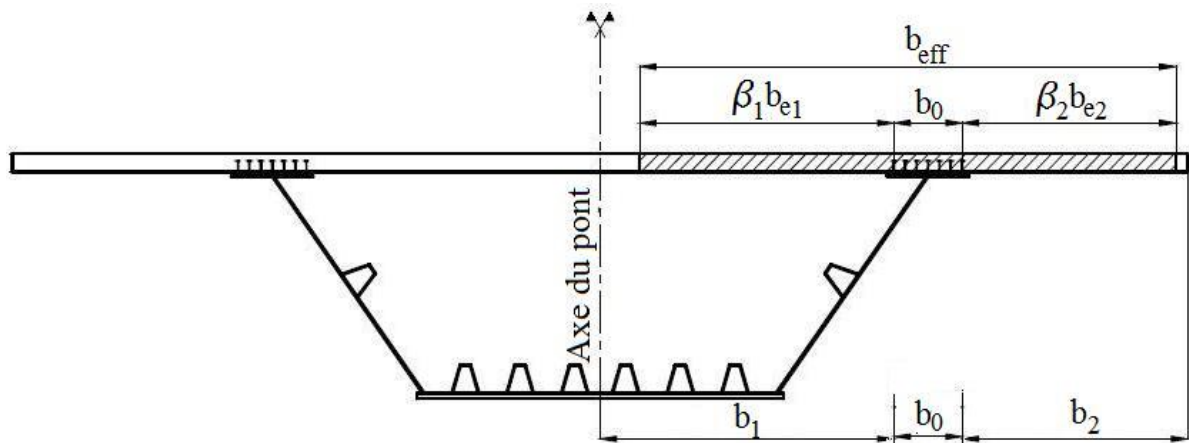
Largeur efficace de la dalle dans une section du pont caisson.
